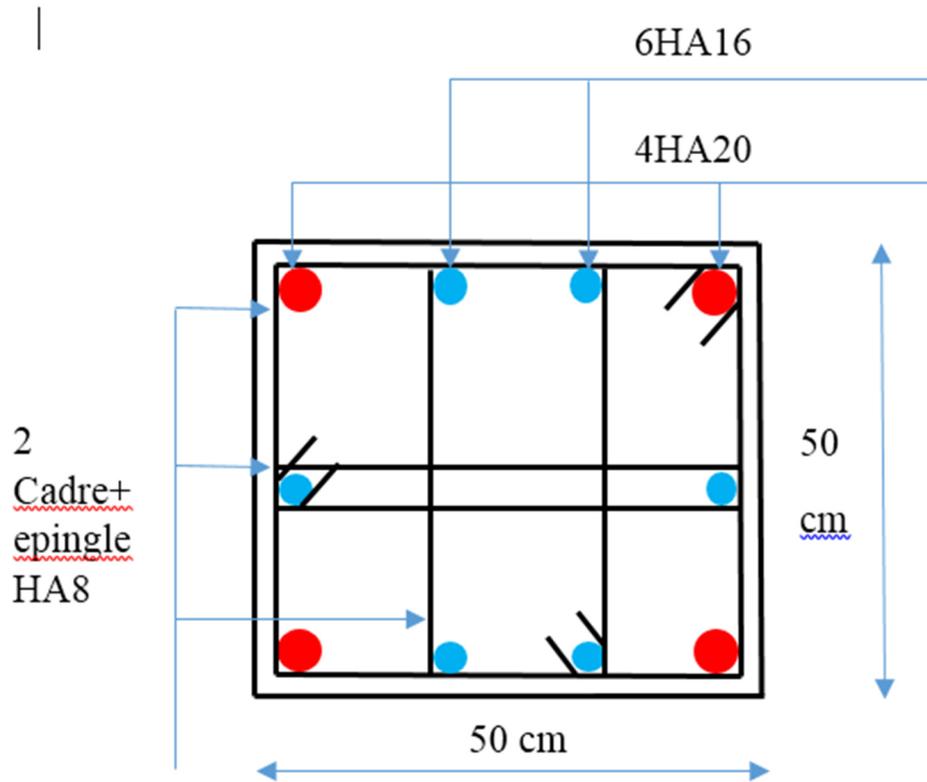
Schéma de ferrailage des poteaux (50x50)
